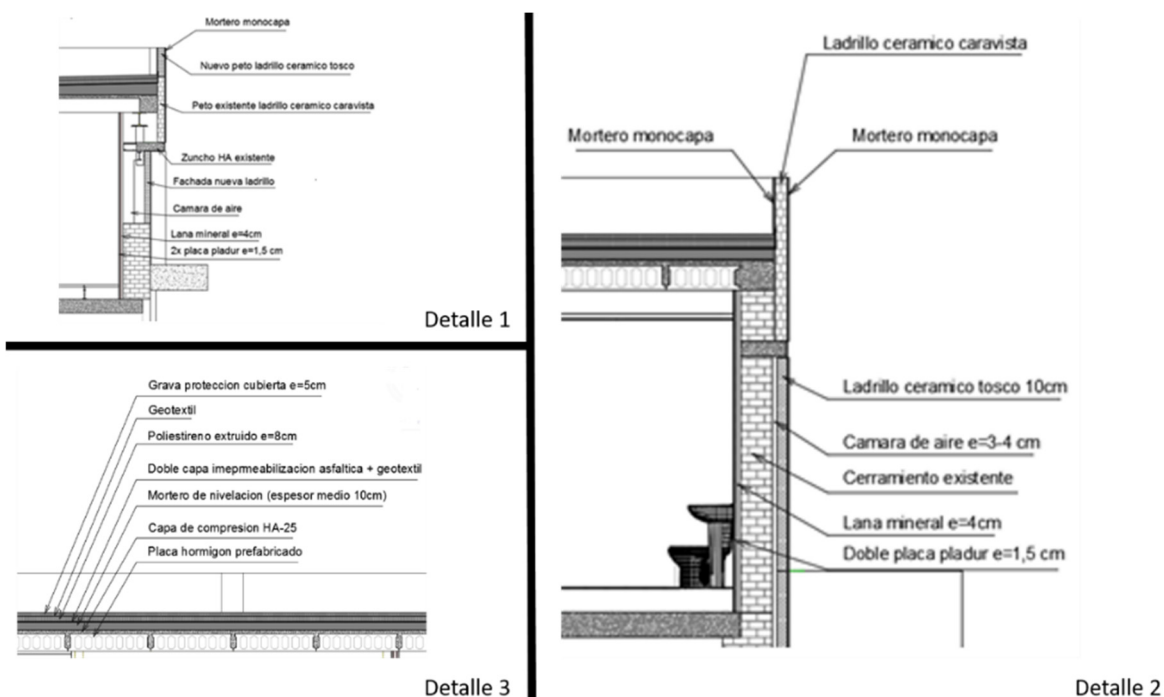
Detalles constructivos: Detalle 1: Sección pared este y oeste, Detalle 2: Sección pared norte y sur, Detalle 3: Sección cubierta. Fuente propia.
